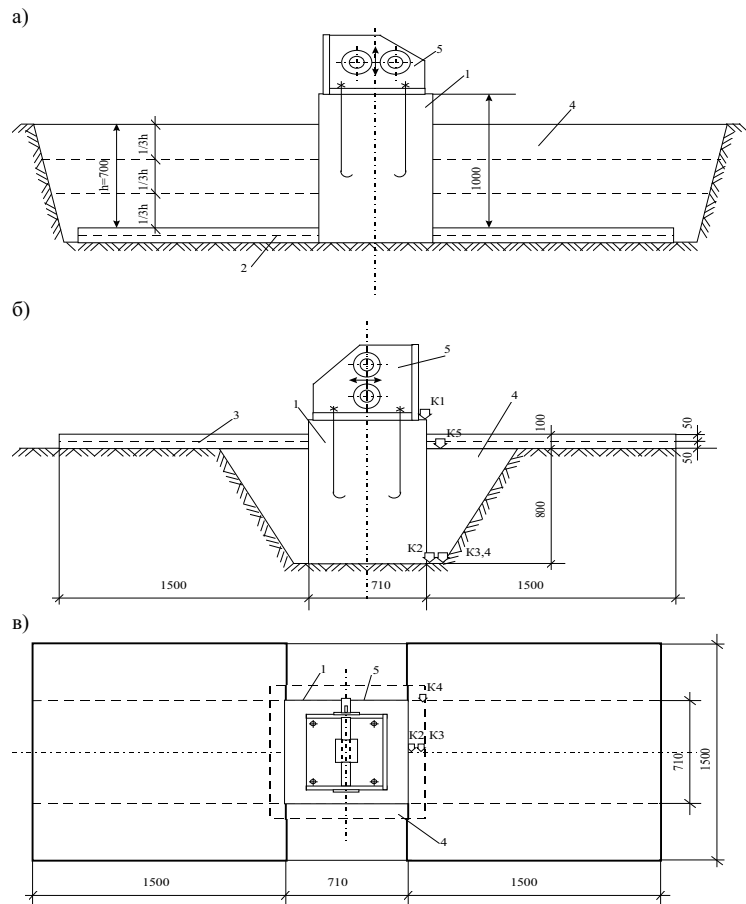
Экспериментальный фундамент: а – фундамент с нижним расположением плиты; б – фундамент с верхним расположением плиты; в – план фундамента и установки; 1 – массивная часть фундамента; 2 – нижняя плита; 3 – верхняя плита; 4 – обратная засыпка; 5 – вибратор.
